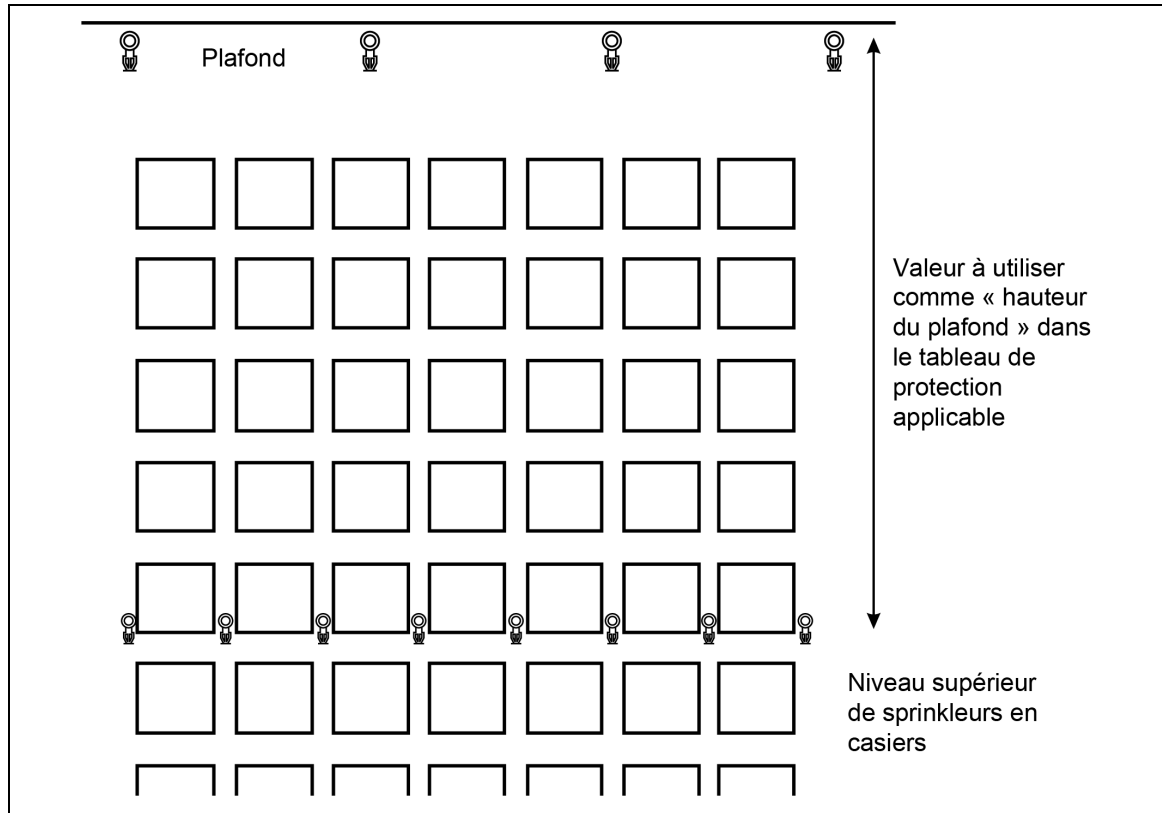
Détermination de la hauteur de plafond dans le tableau de protection applicable
